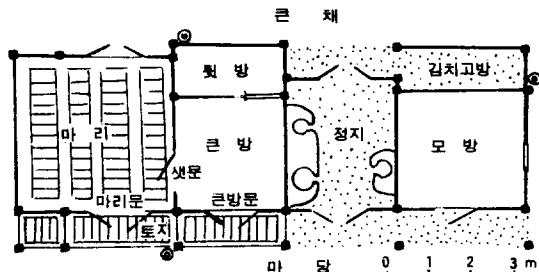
邑里의 鄭成漢氏宅 큰채 平面図
